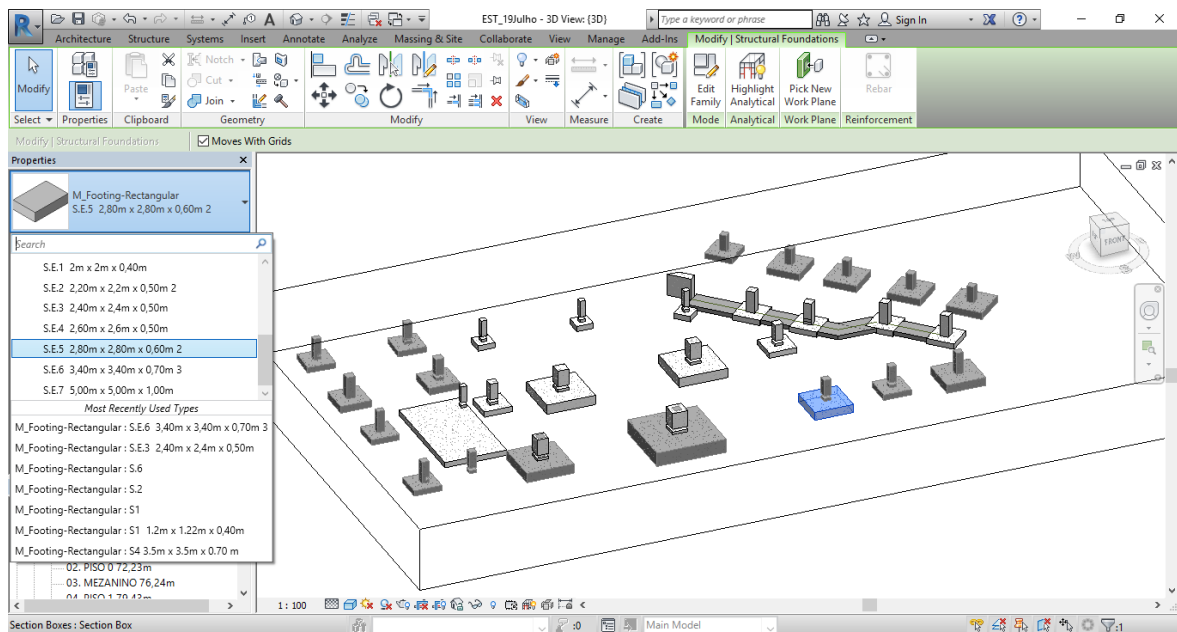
FUNDAÇÃO MODELADA E LISTAGEM DAS DIFERENTES DIMENSÕES DE SAPATAS (FOOTING) USADAS
